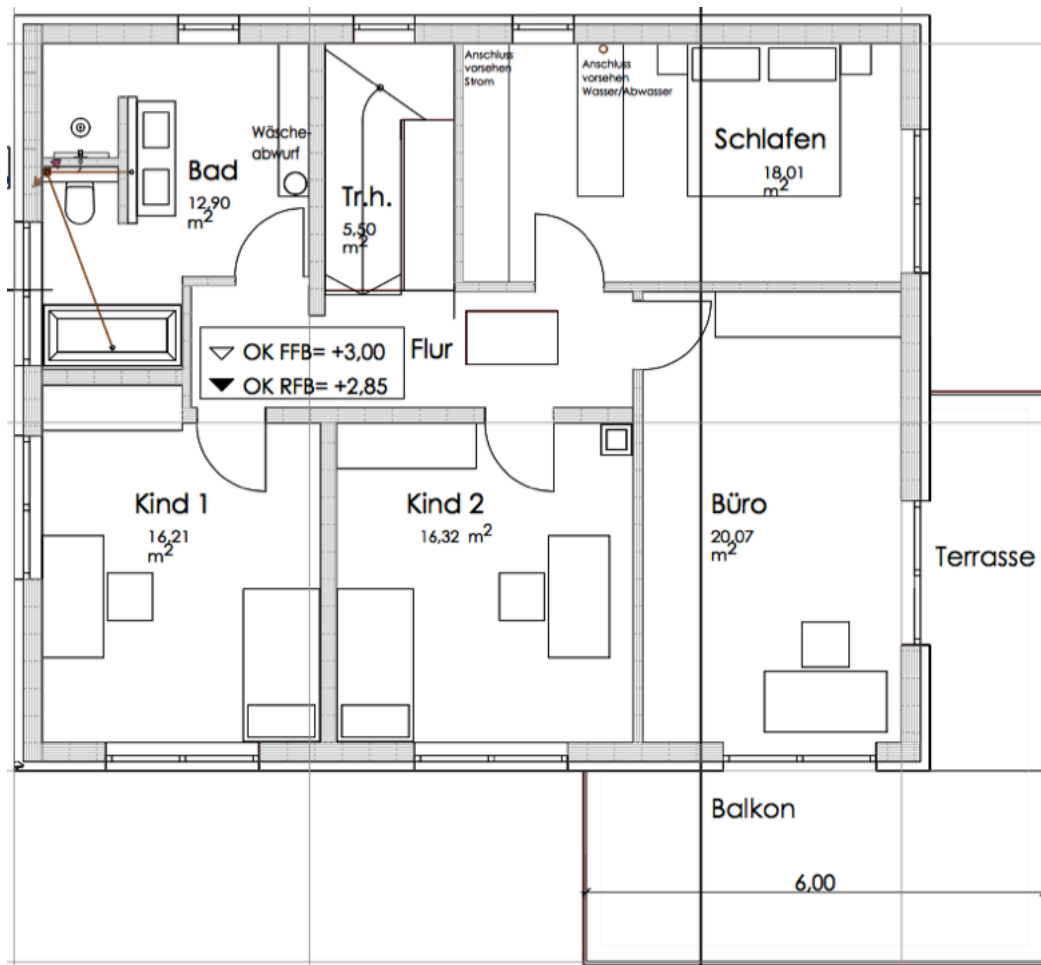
Grundriss 1. Obergeschoss
